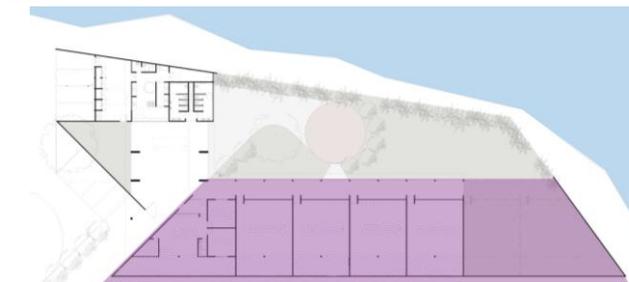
, 168 – Escola Novo Mangue - Planta Baixa e Perspectiva – Setor 3.
